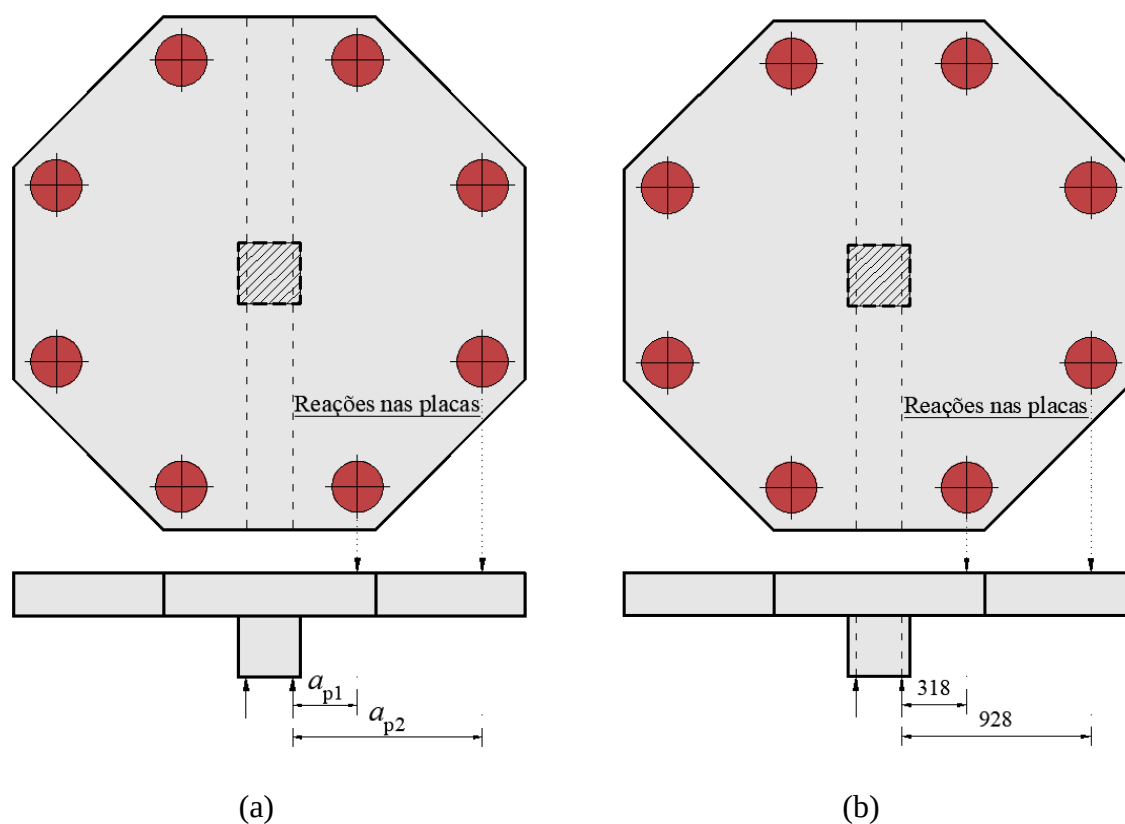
Ilustração do cálculo do momento solicitante para as lajes (Adaptado de Ferreira, 2010).
